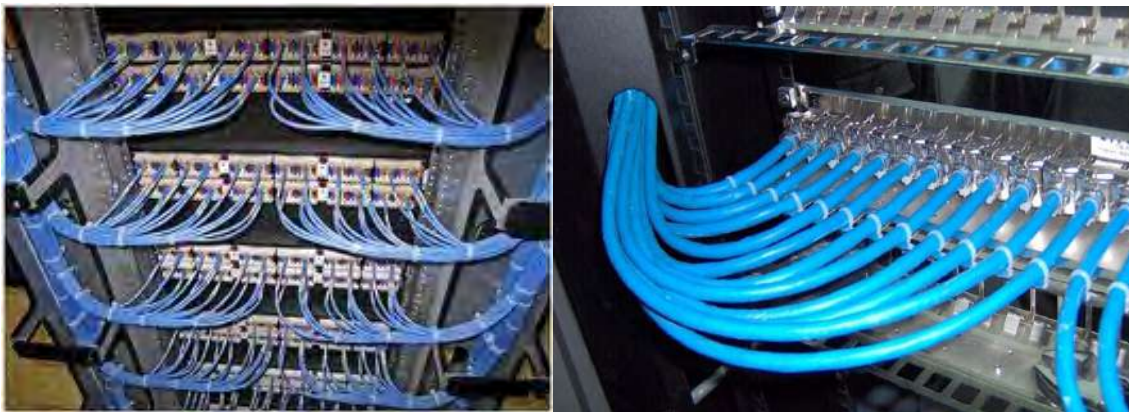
Gabinetes de conexión del cableado estructurado horizontal (terminales de conexión).
